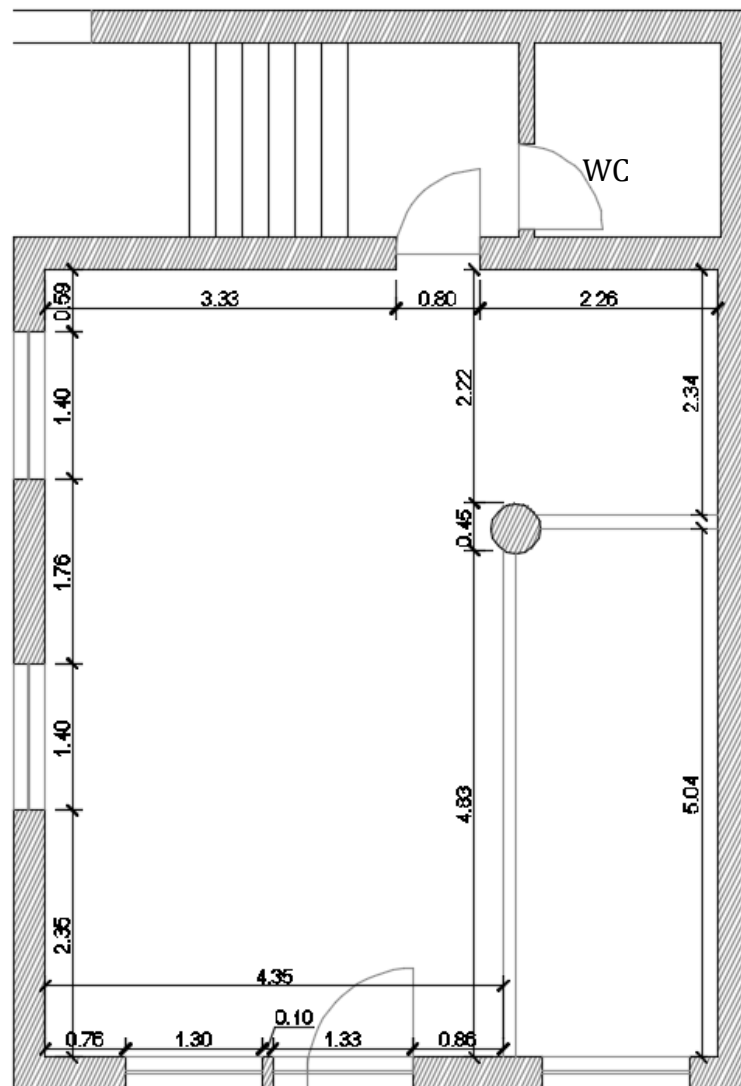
Planta do espaço. Retificação de medidas. Visita ao local. Fonte: autor
